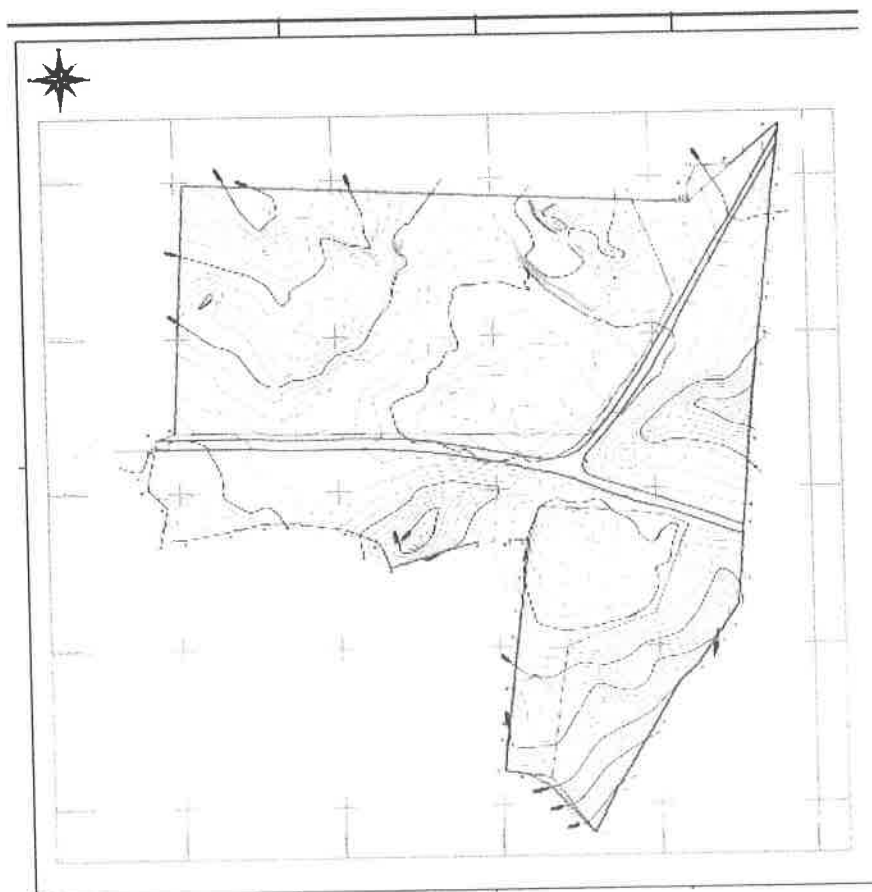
Levantamento Topográfico dos Lixões – futuro aterro sanitário
